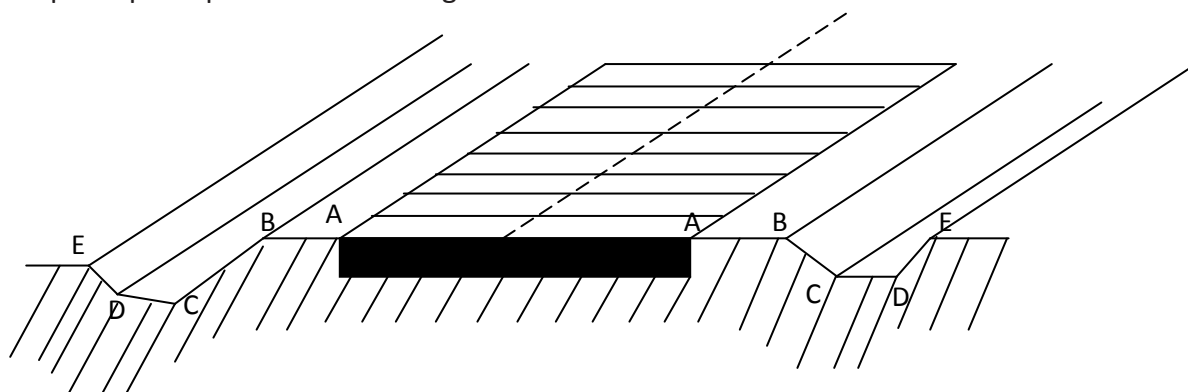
Trupi i rrugës dhe elementet e saj.
